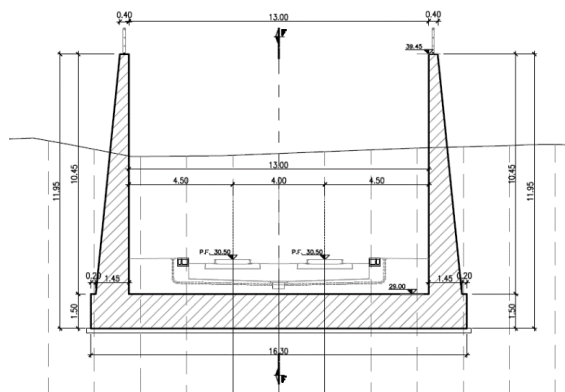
Sezione muro di imbocco (Hmax=10.45 m)
